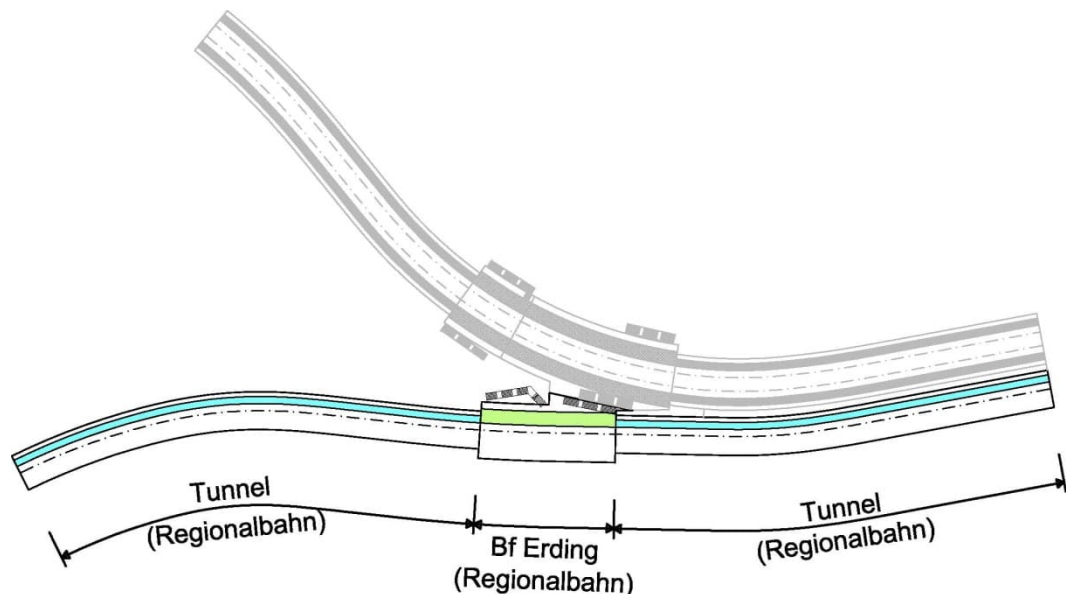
Walpertskirchener Spange Schemadarstellung Tunnel/Bf
